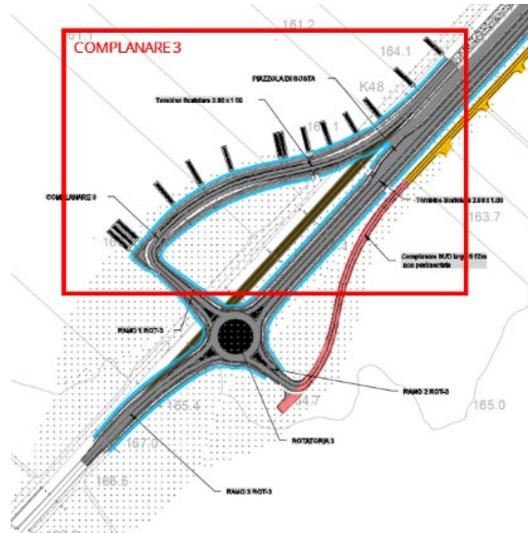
COMPLANARE 3: PLANIMETRIA DI PROGETTO
